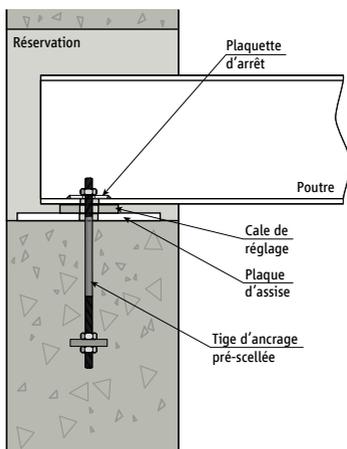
Liaison d'une poutre par une réservation dans un voile
